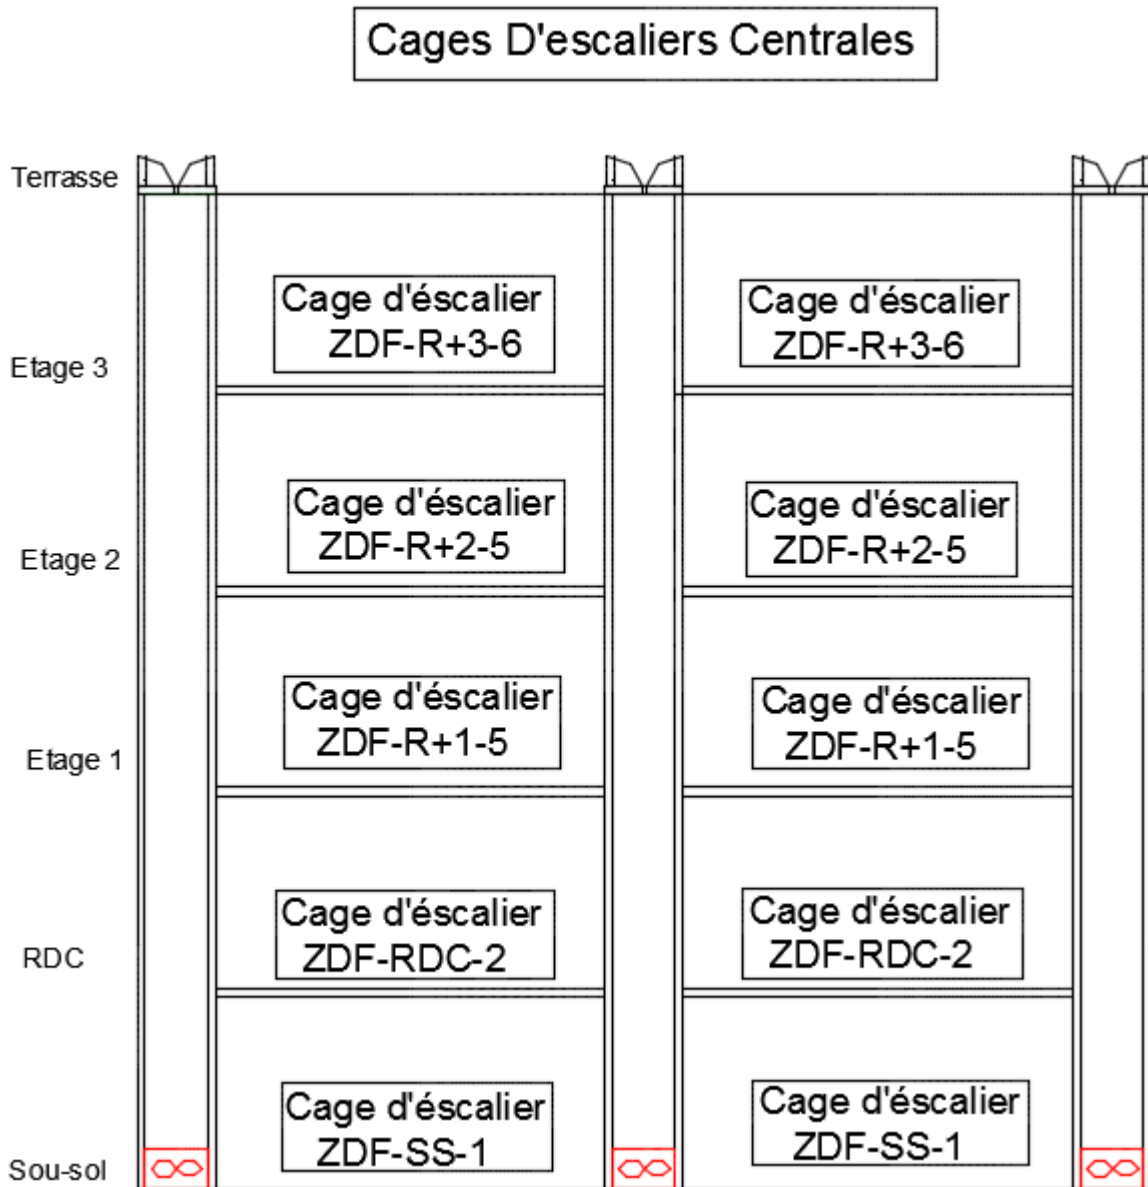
Implantation de système de désenfumage (cages d'escaliers centrales).
